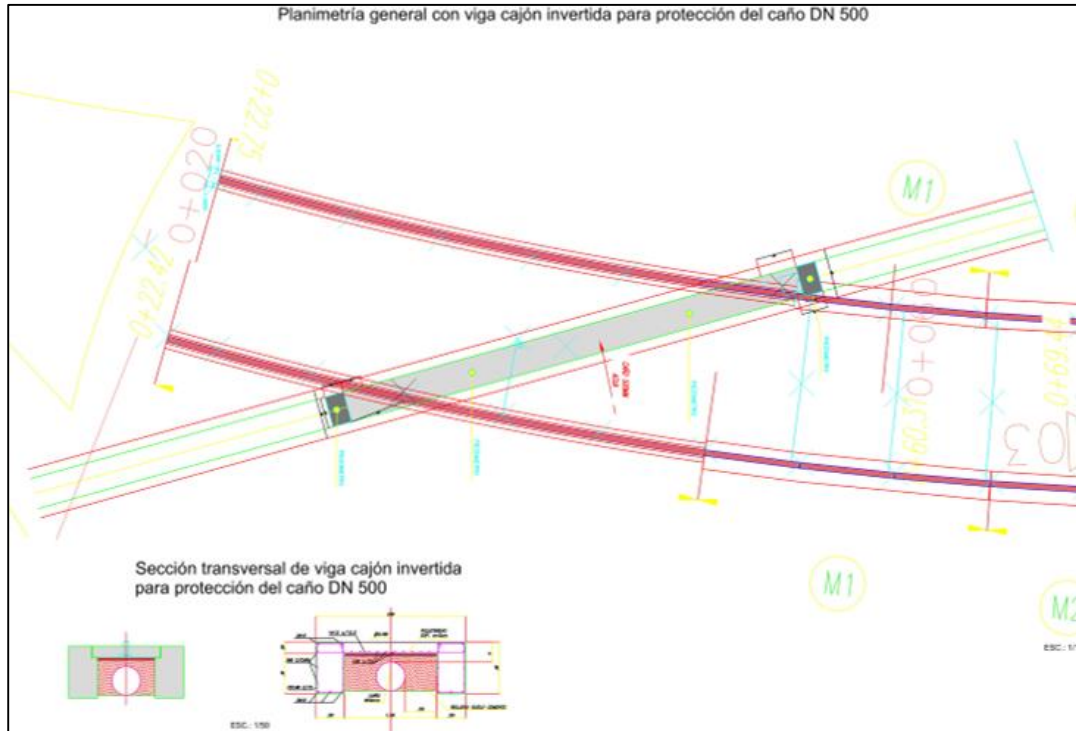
Planimetría y detalle de la viga invertida para protección caño DN 500. (PLANO N° 16)
